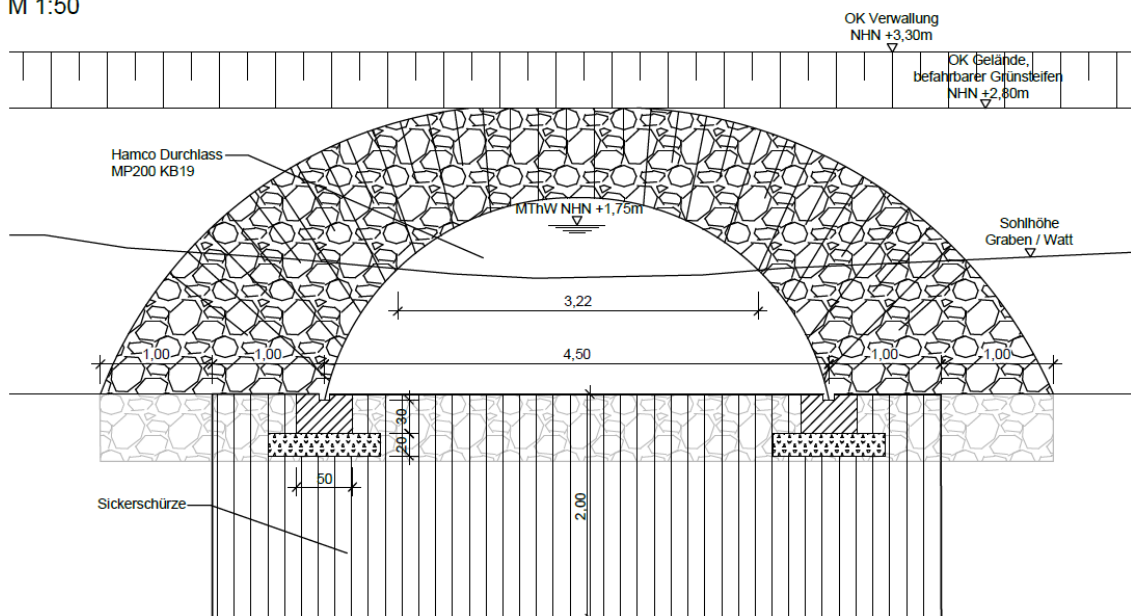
Durchlassbauwerk mittlere Rinne, Ansicht Einlaufbauwerk (Planausschnitt Detail B, Anlage 2.5, Blatt 1)
